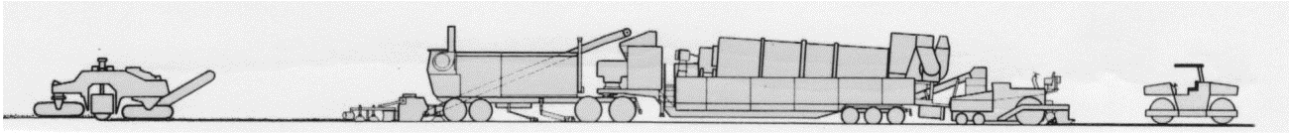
Vista del conjunto de los equipos que componen el tajo.
